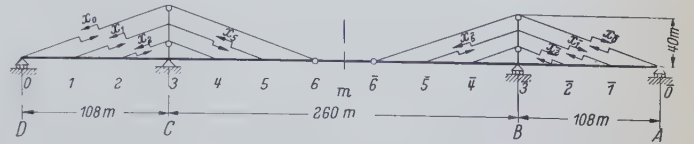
8fach statisch unbestimmtes Grundsystem des Hauptträgers
